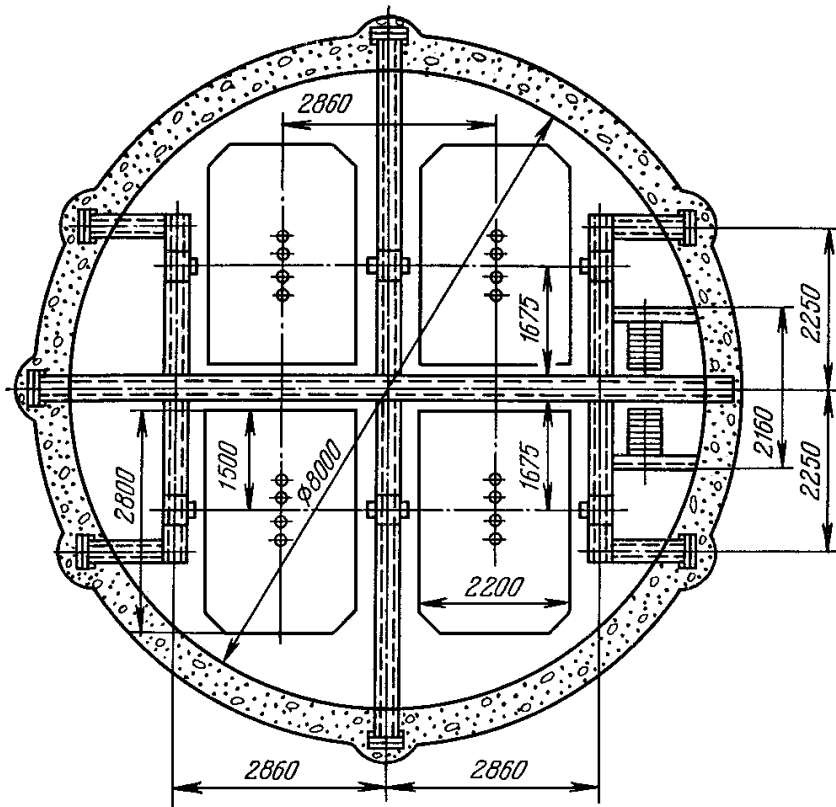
Сечение скипового ствола диаметром в свету 8 м со сварными расстрелами
